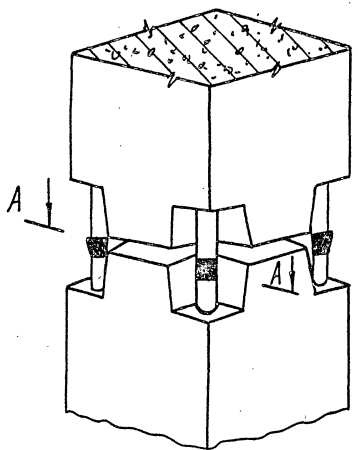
Схема послойного вскрытия сварного шва стыкового соединения спаренных стержней арматуры. 1,2,3,4 последовательность вскрытия.
